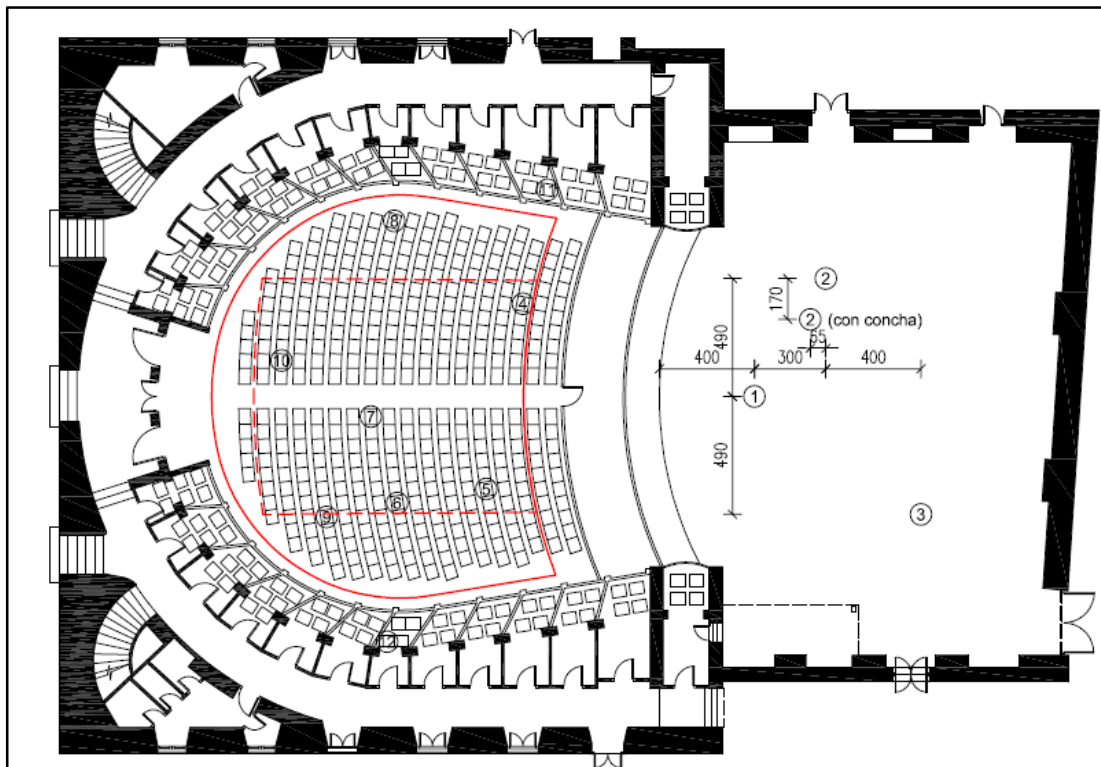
Posición de fuente y receptores en el proceso de medida, PLANTA BAJA.
